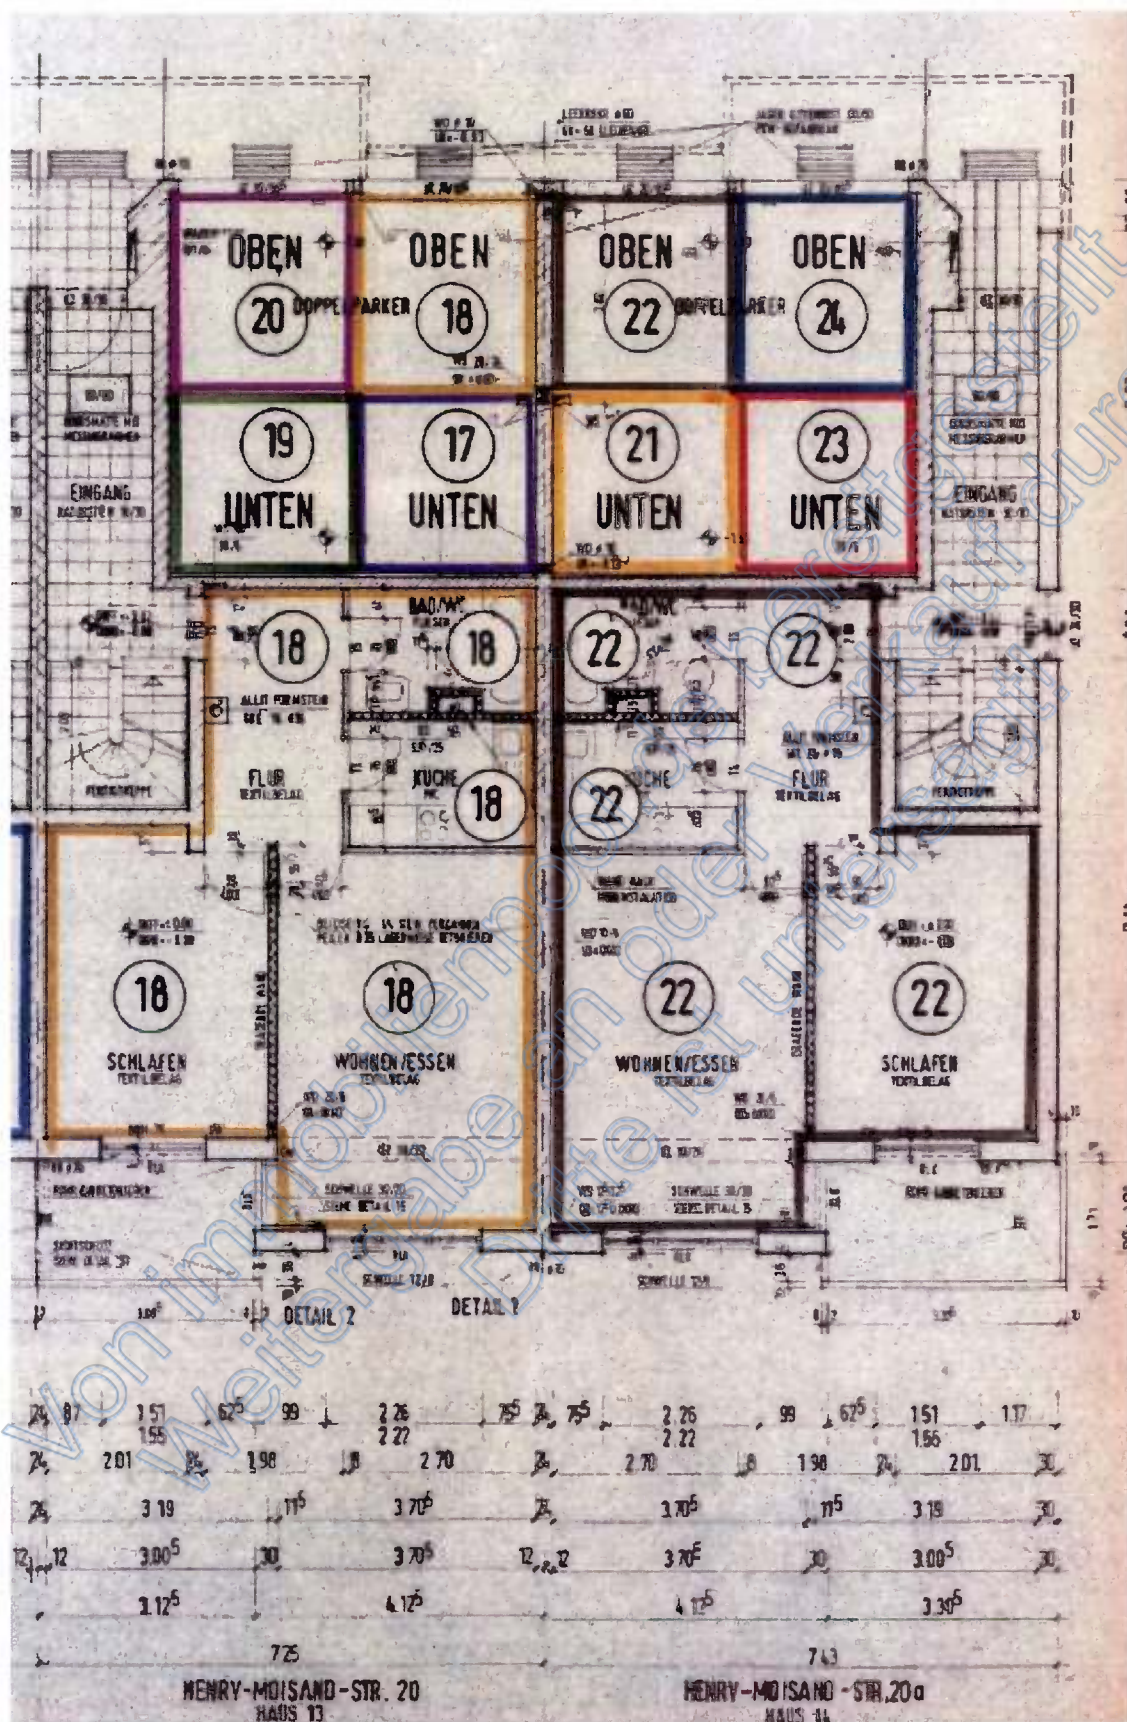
Auszug Grundriss Erdgeschoss Haus 13 und 14, Henry-Moisand-Str. 20, 20 a; Quelle: Bauakte
